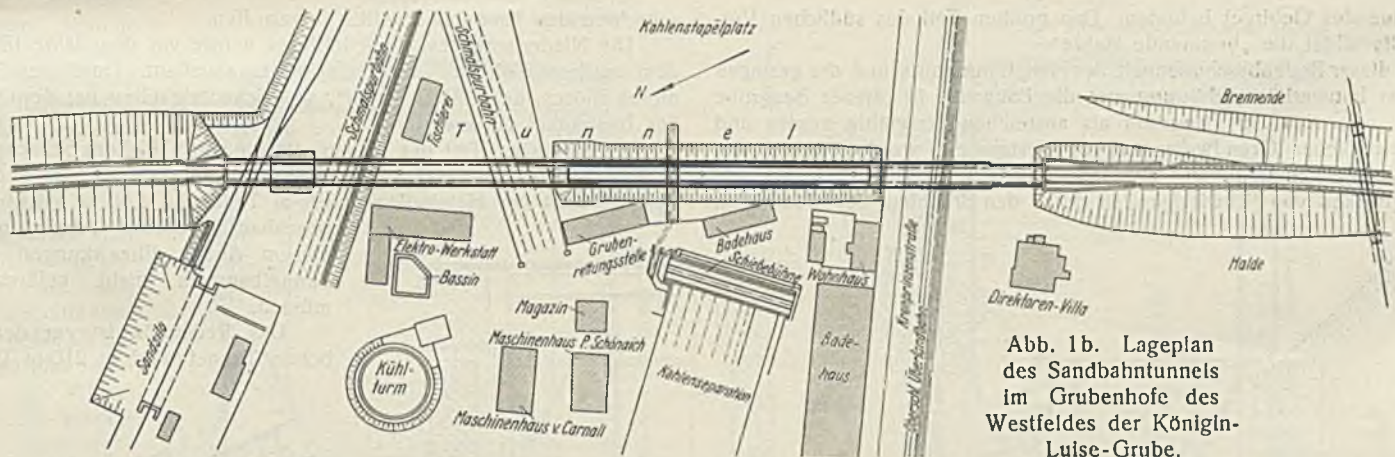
b. Lageplan des Sandbahntunnels im Grubenhofe des Westfeldes der Königin-Luise-Grube.
